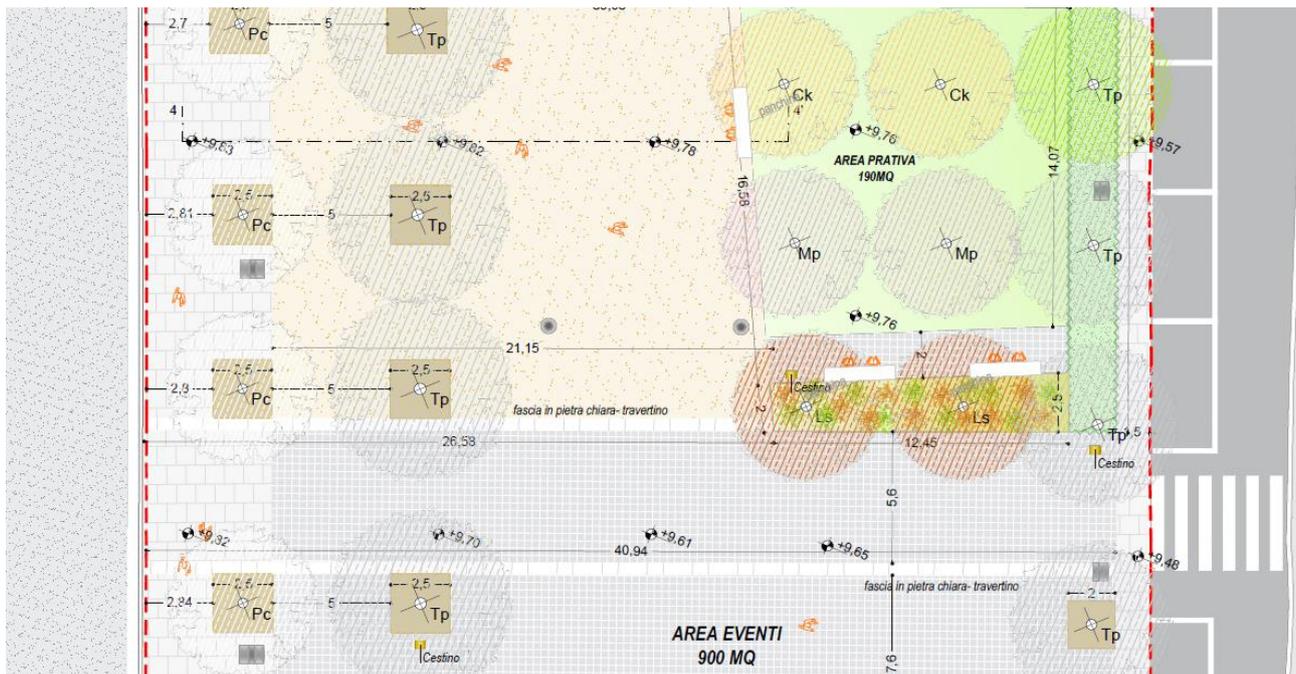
Estratto dell’elaborato T.04 – Planimetria – Stato di progetto
